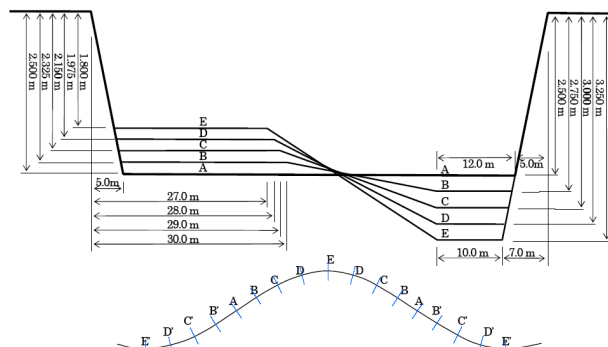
実験水路断面図 (模型はこの 1/100 縮尺で製作)
